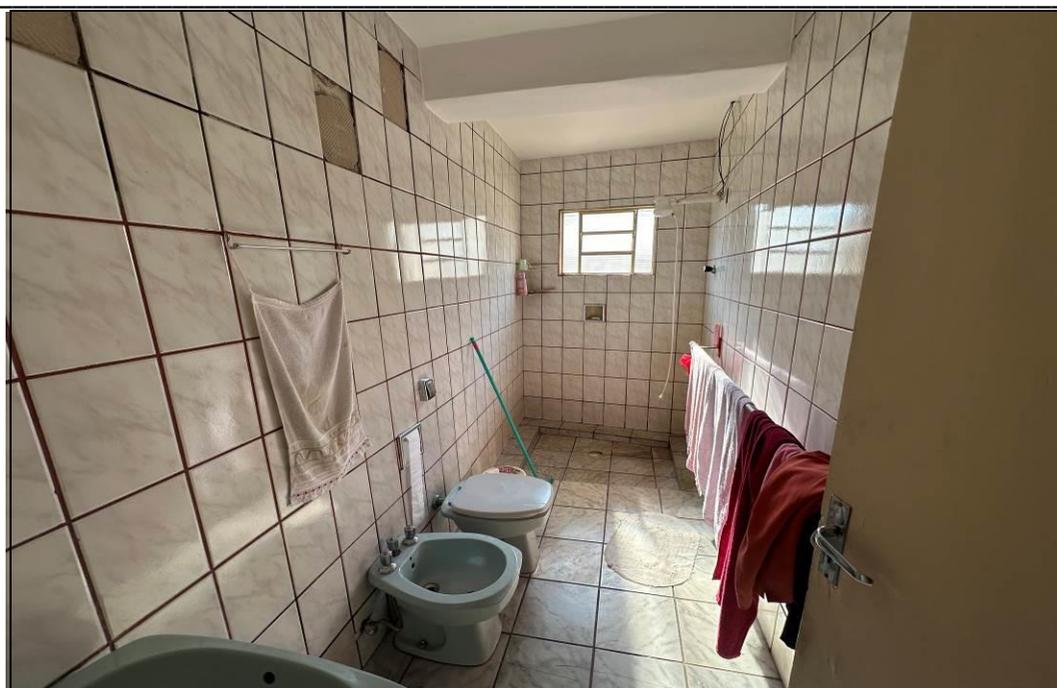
Vista parcial do banheiro do imóvel com alguns azulejos faltando.
